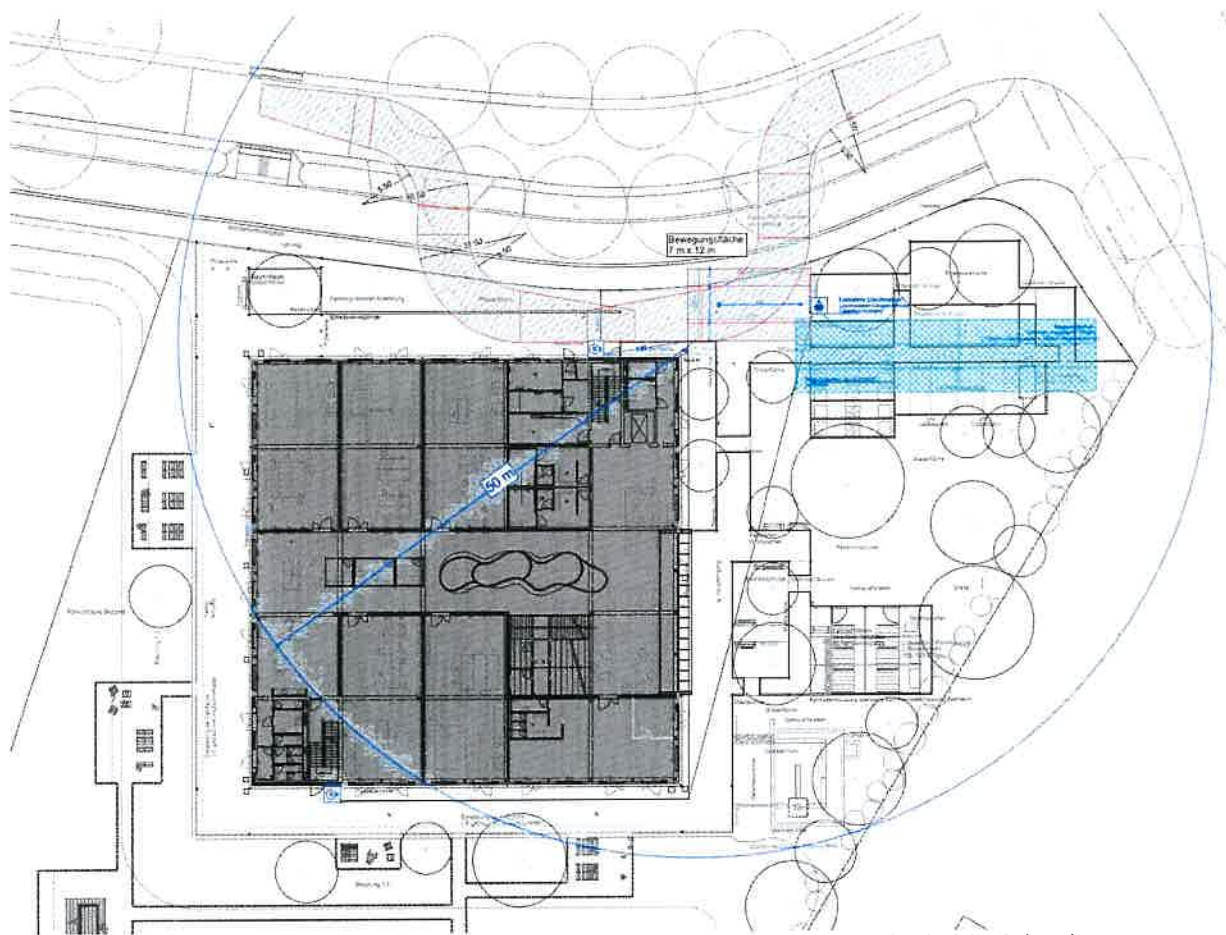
Lageplan mit markiertem Neubau sowie Löschwasserquellen (Lavaland) (auch siehe Anhang)
